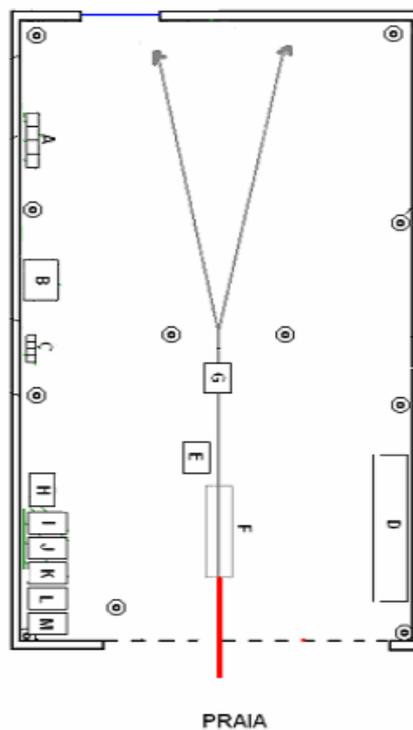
Desenho esquemático da estrutura de uma Base Guincho.
